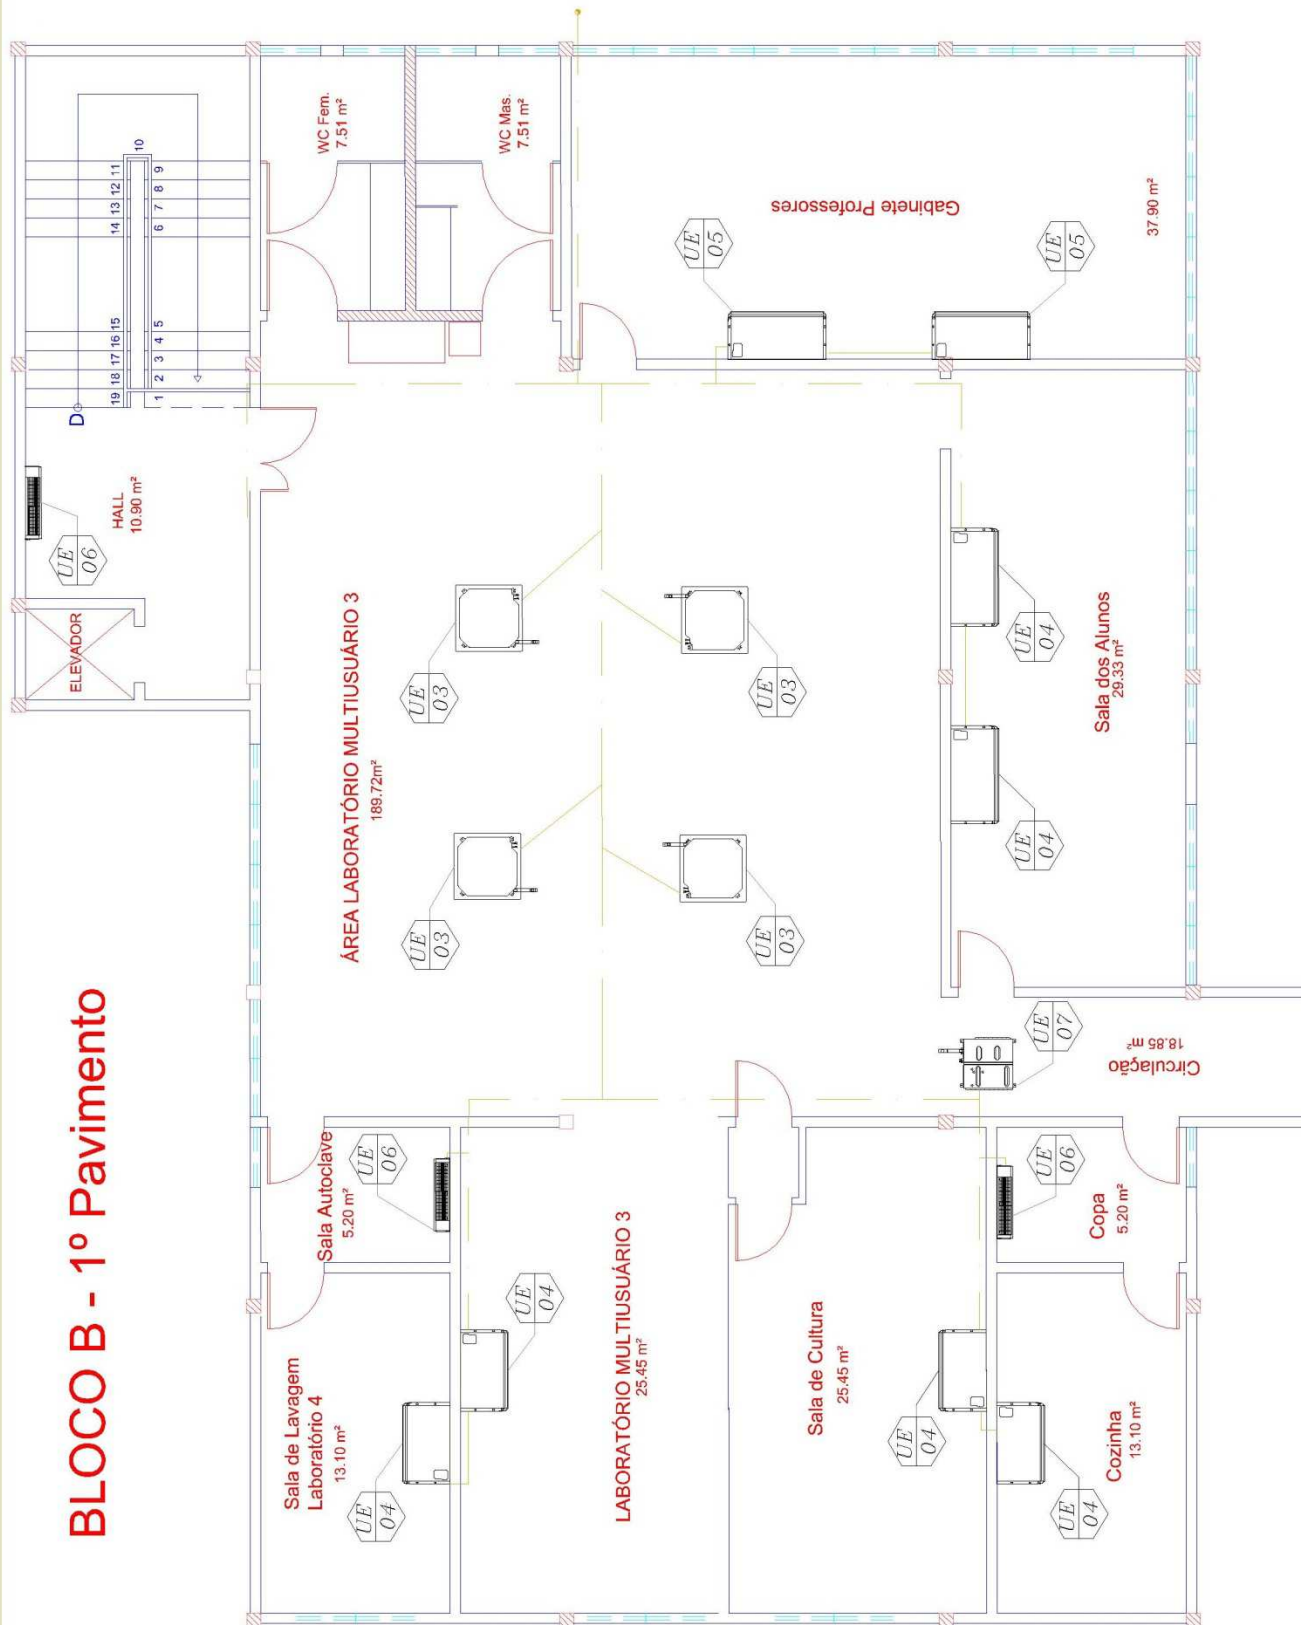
Disposição das unidades no Bloco B – 1º Pavimento
